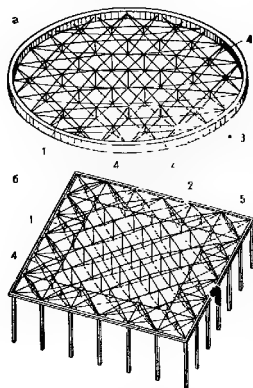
Схемы покрытий из перекрещивающихся вантовых ферм
